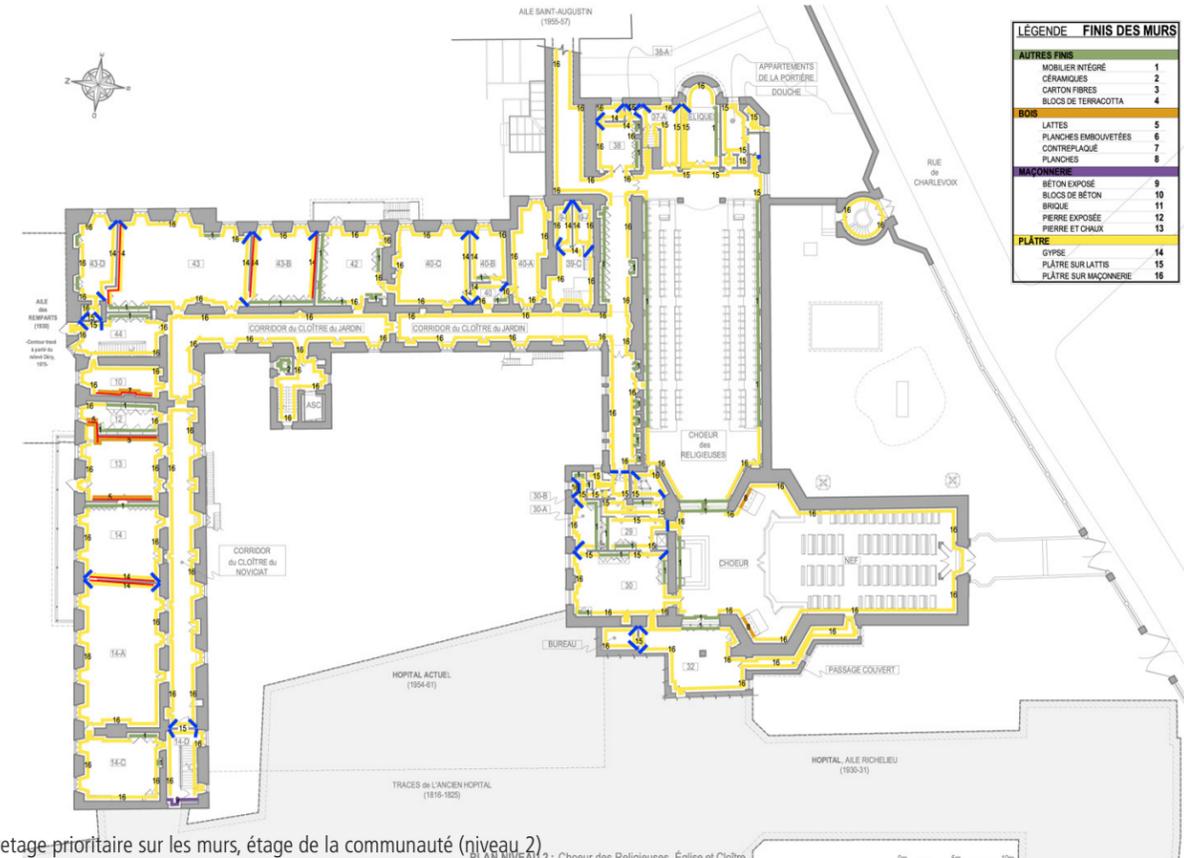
Plan de curetage prioritaire sur les murs, étage de la communauté (niveau 2)
